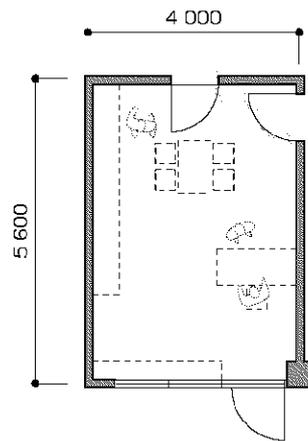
(36) Plan du bureau du directeur adjoint du Centre
